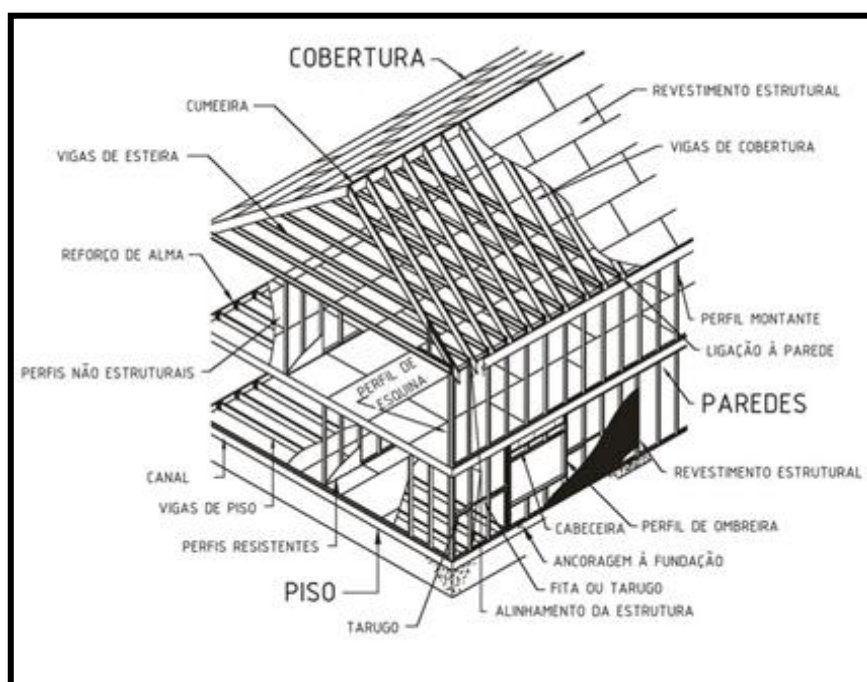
Componentes da estrutura em *Light Steel Framing* [14]
